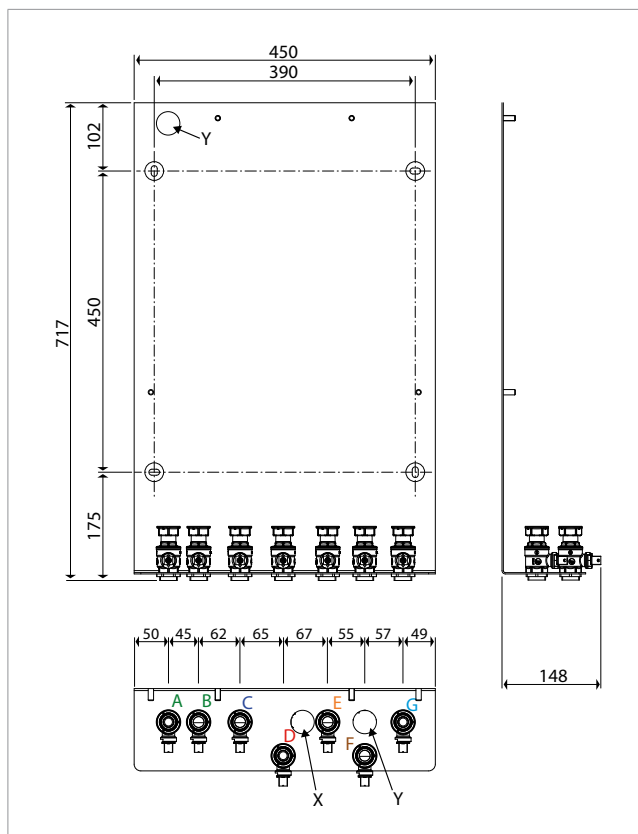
dimensioni in mm (dima GE551Y082) / dimensions in mm (GE551Y082 template)
